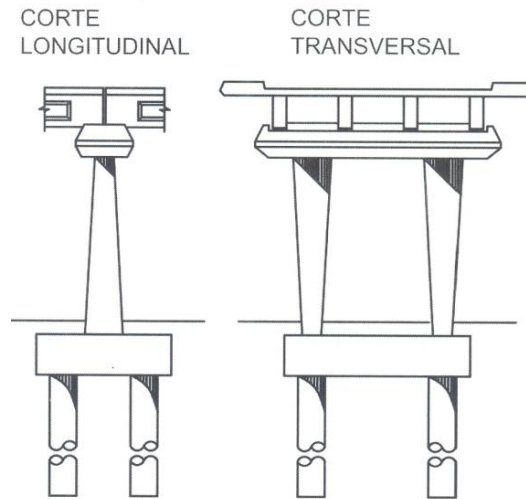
Pilar con dos columnas en forma de pórtico transversal (Somenson, H. 2005)
